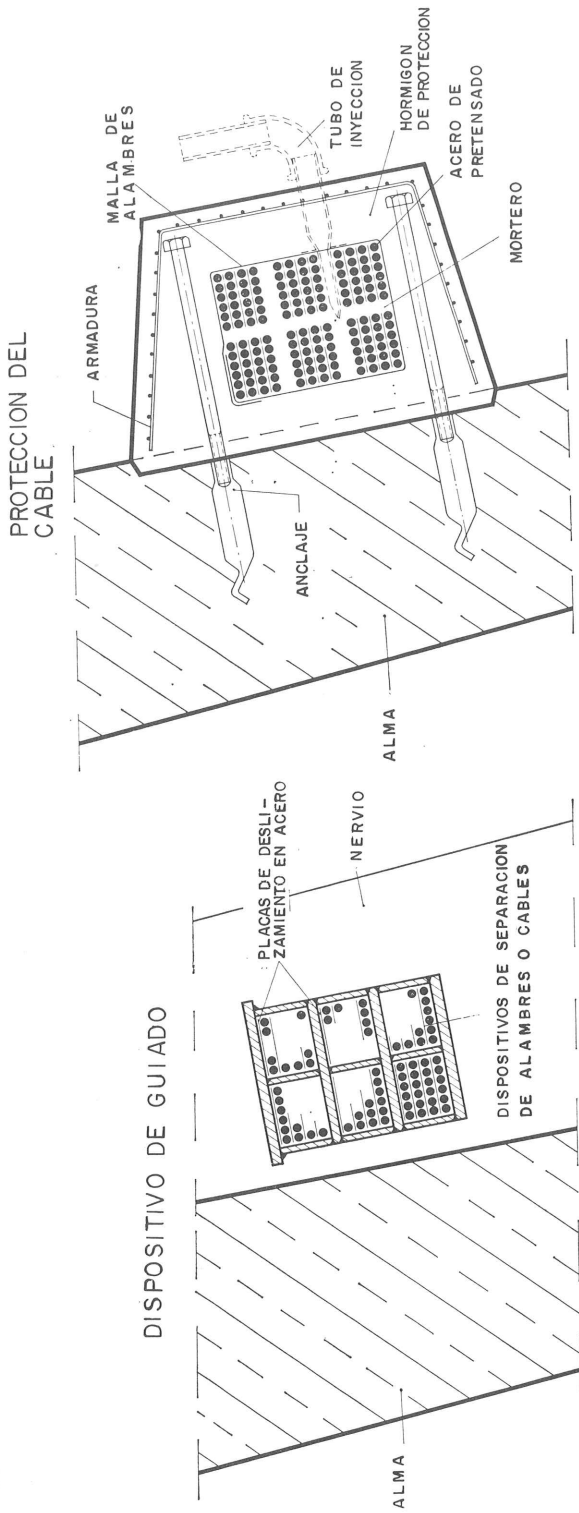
Detalle de la disposición de los cables en el exterior de las almas.
